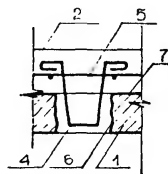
Нарращивание сверху с устройством железобетонных шпонок
